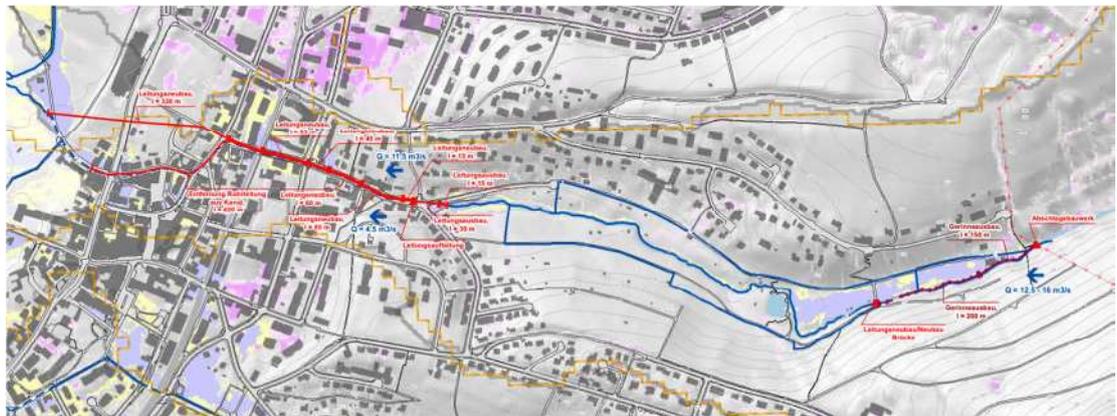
Ausschnitt aus dem Situationsplan Variante 2
